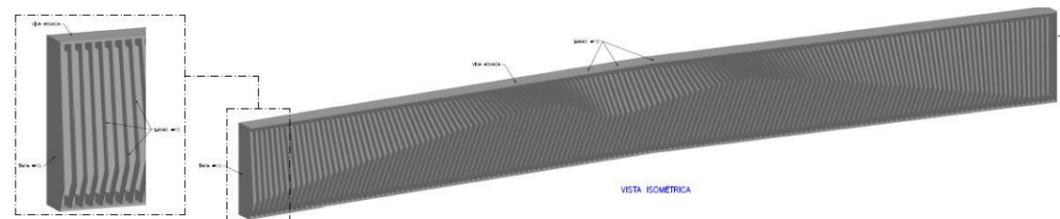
Detalle de la estructura metálica de la pasarela. Fuente: Proyecto
